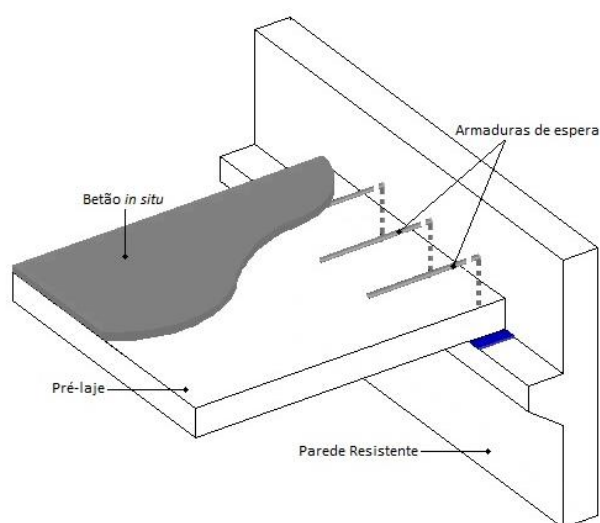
Ligação Laje - Parede sem betonagem *in situ* do nó
